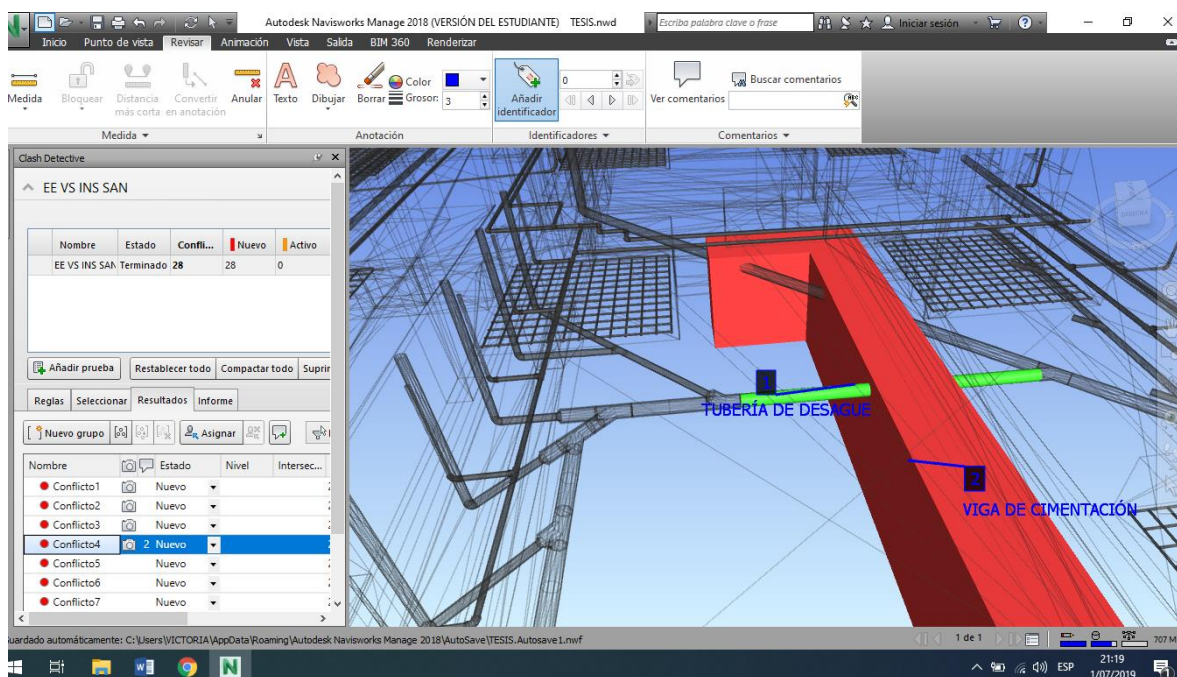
Interferencia entre tubería de desagüe y viga de cimentación.
